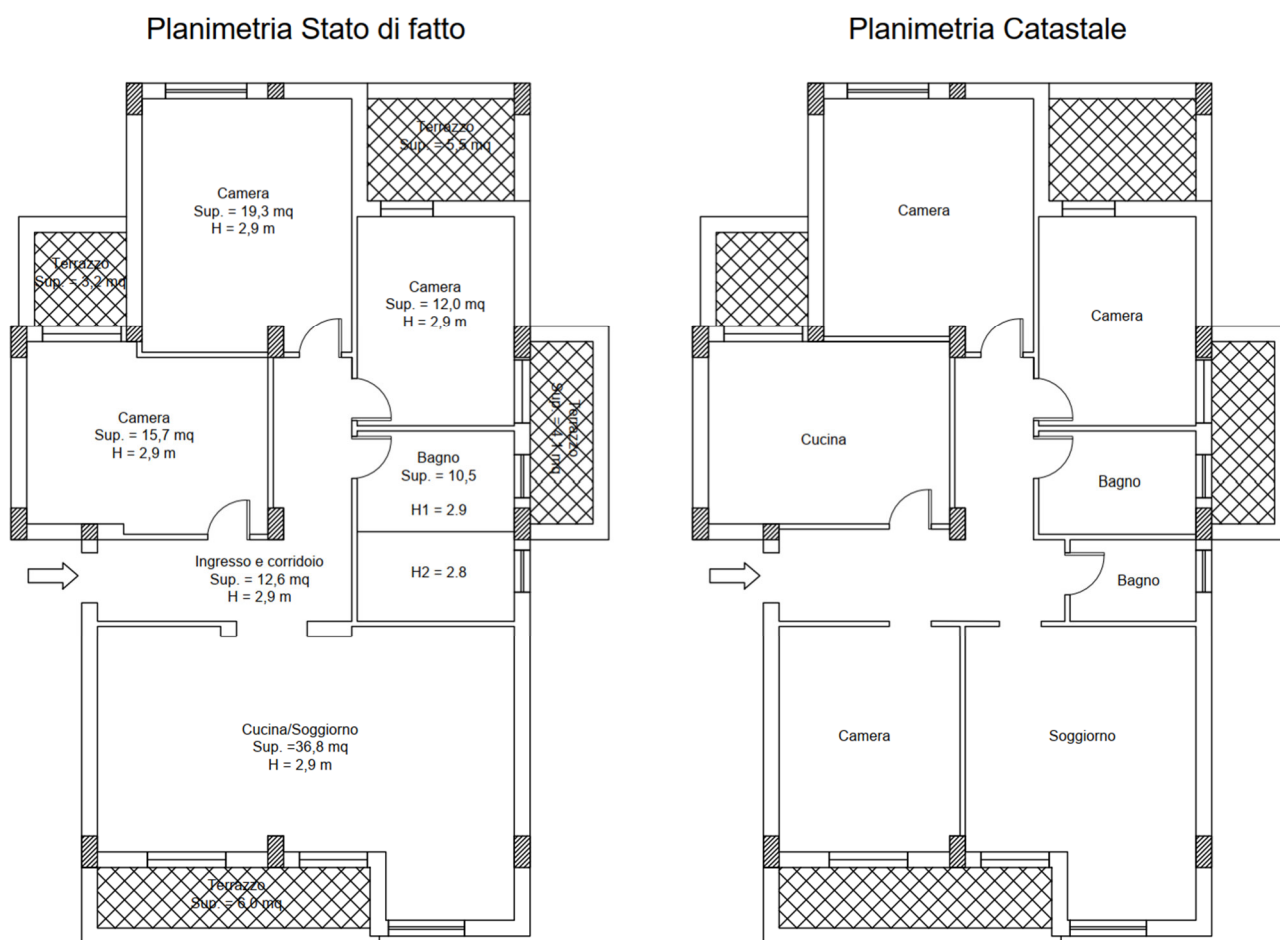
Planimetria stato di fatto e planimetria catastale catastale
